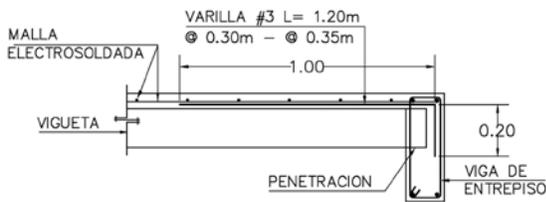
Detalle de refuerzo sísmico paralelo a las viguetas
